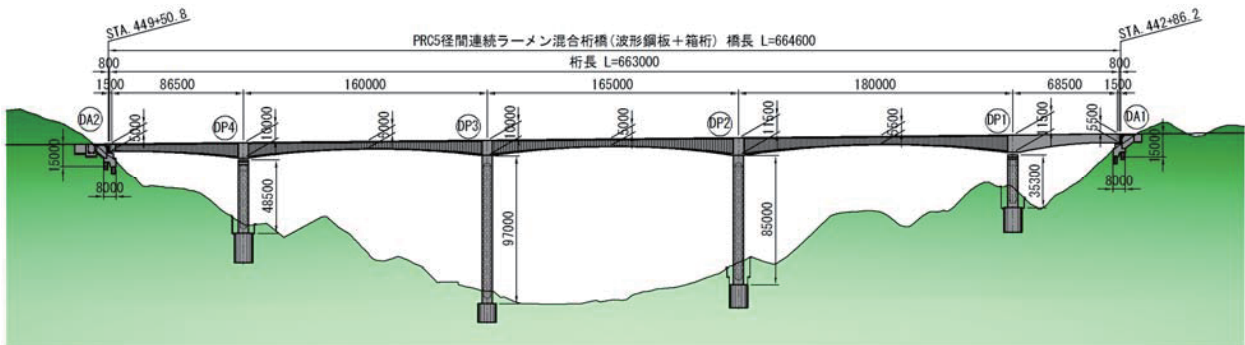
信楽川橋 (仮称) 下り線 橋梁一般図
